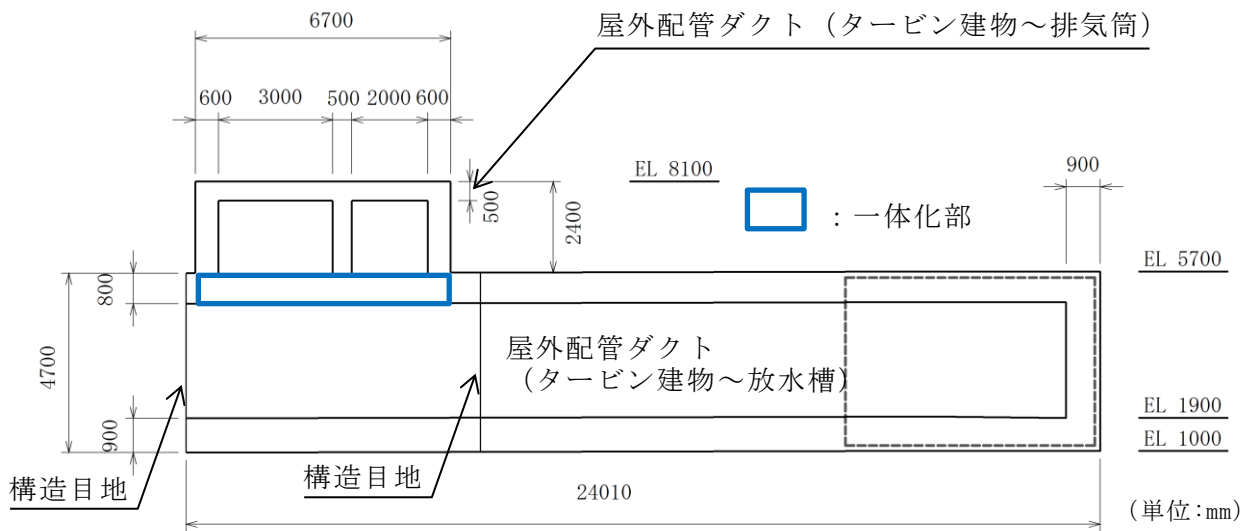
(2) 屋外配管ダクト (タービン建物～排気筒) 断面図 (B-B 断面)
